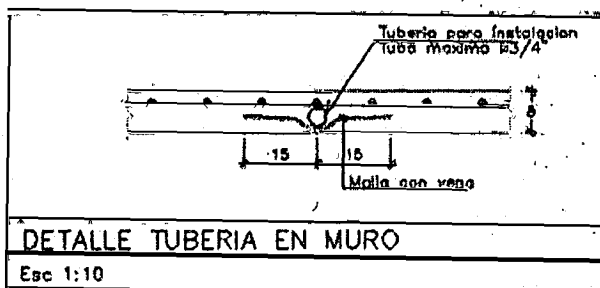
Detalle de tubería y refuerzo en muro tipo. (Tomado del plano estructural n.º02. V.1. Planta de muros estructurales piso tipo. Marzo 2018)
